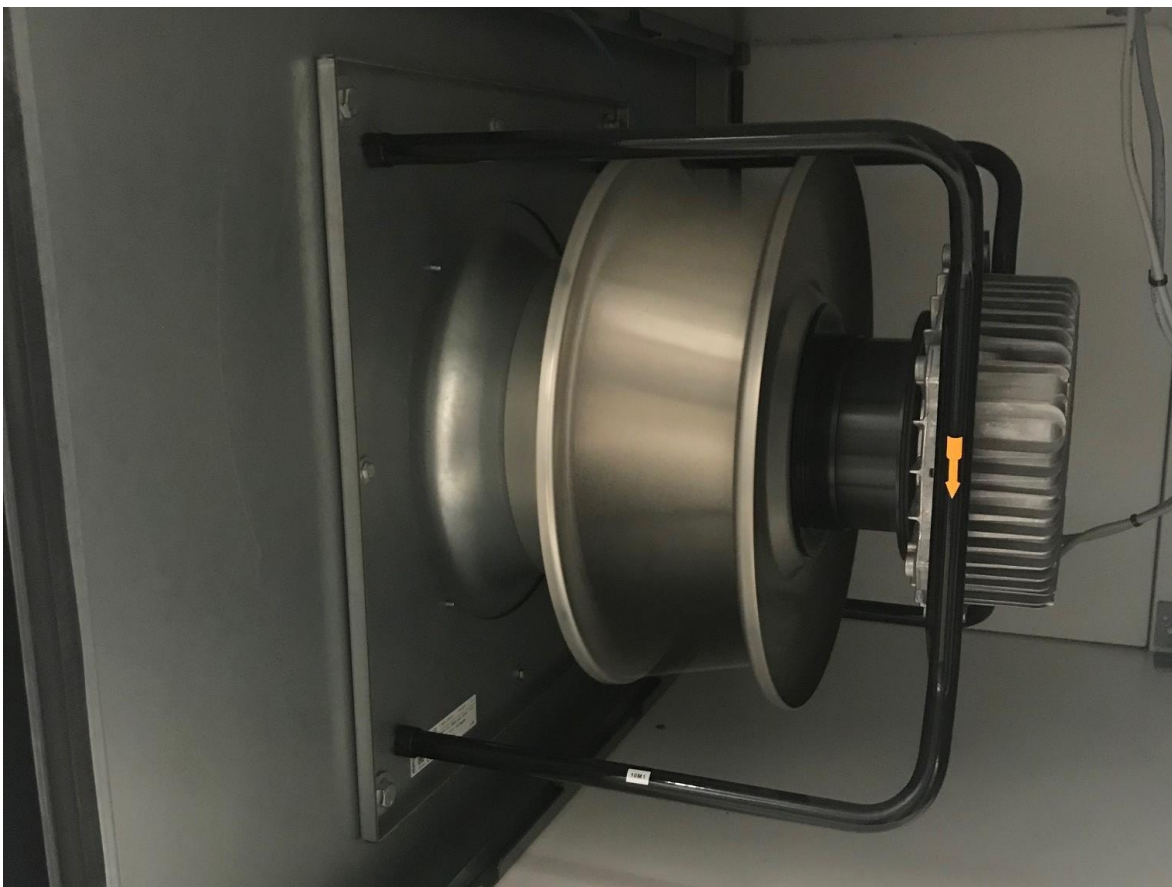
Ventilator (Quelle: Stadt Göttingen Fachbereich Gebäude)
